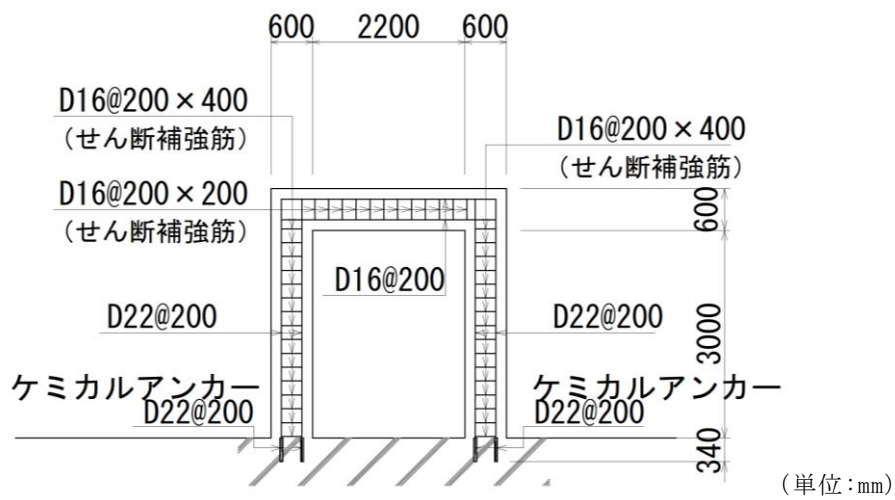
ボンベ庫 概略配筋図 (A-A 断面)
